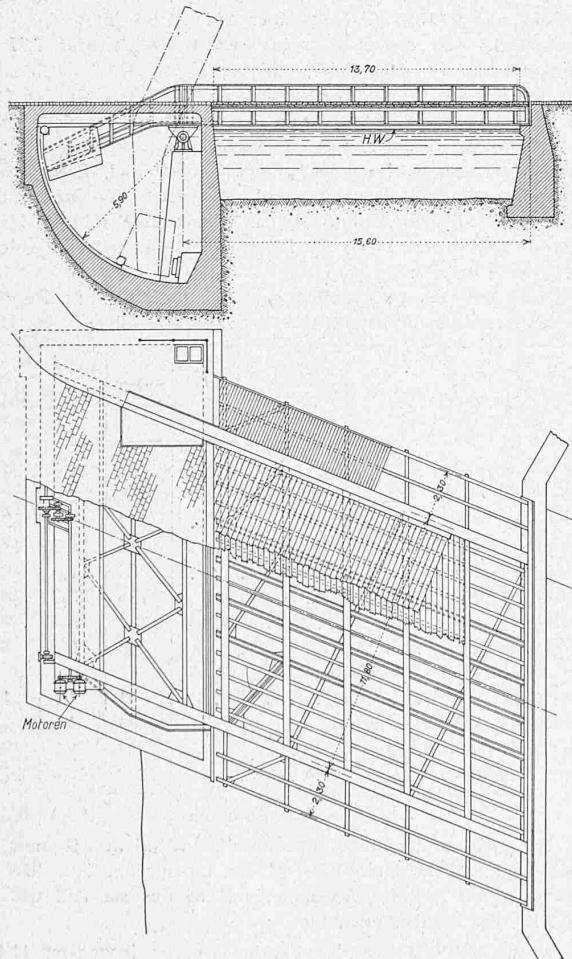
und 2. Grundriss (Draufsicht) und Längsschnitt. — 1:300.
